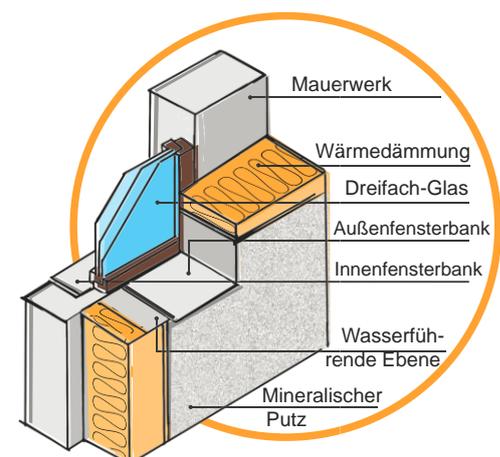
Wenn das Fenster vor der Dämmung der Fassade getauscht werden muss, ist die Installation des Rahmens „außenbündig zum Mauerwerk“ empfehlenswert. © Stadt Riedstadt
